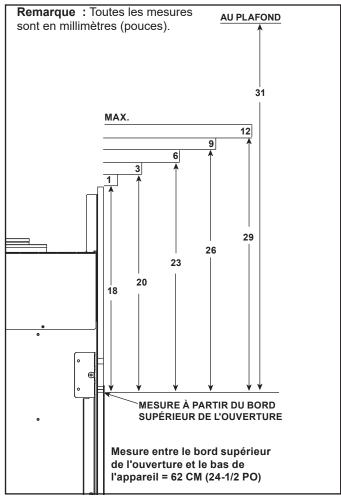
Dimensions des combustibles minimaux verticauxet maximaux horizontaux - CRAVE4836-C, CRAVE4836ST-C, CRAVE6048-C and CRAVE6048ST-C
